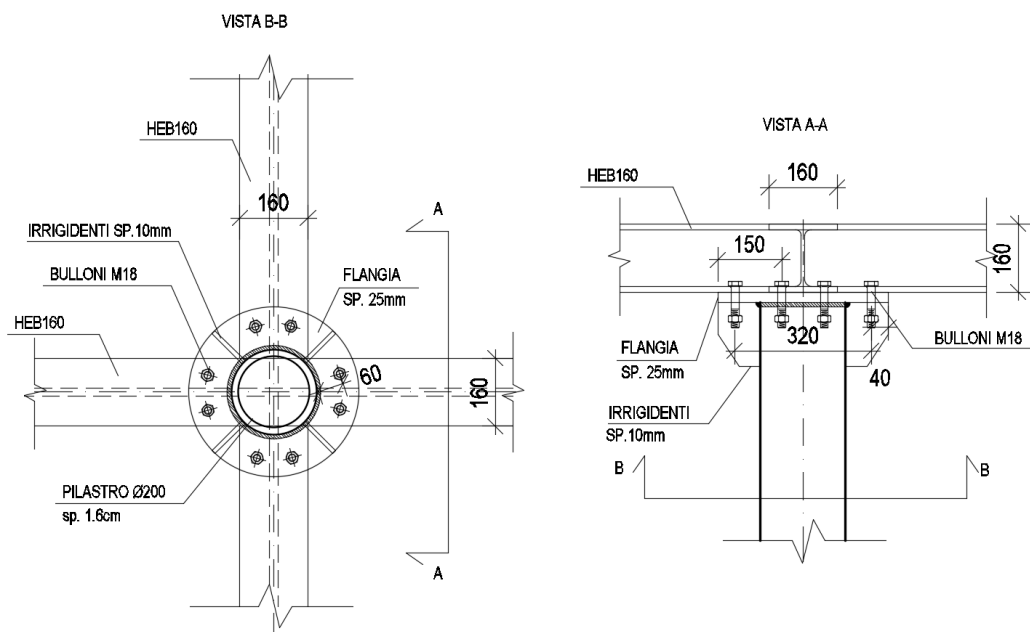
Unione flangiata pilastrini – collegamento con travi di copertura
